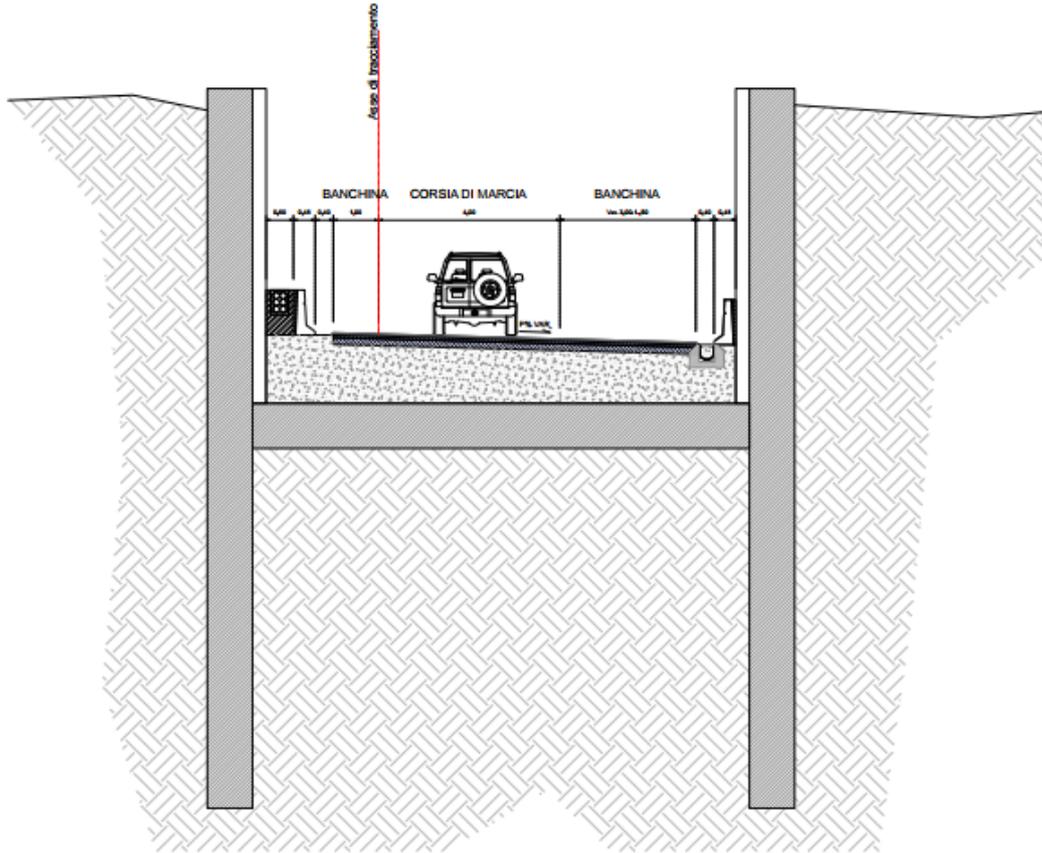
Sezione Tipo tratto in trincea rea diaframmi per il ramo 1
